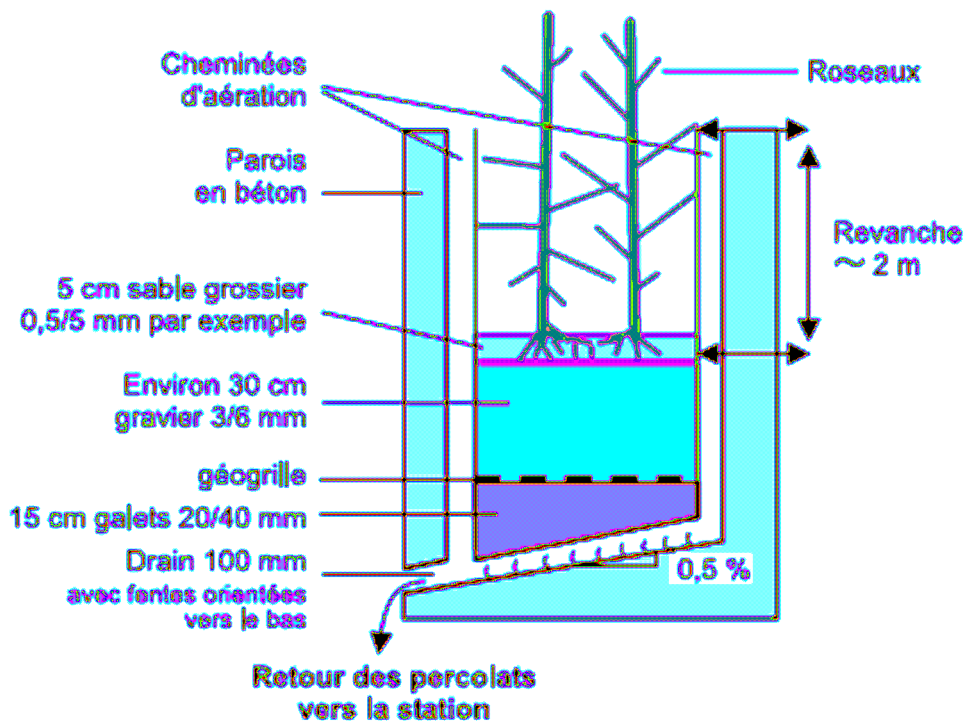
Coupe schématique d'un lit de séchage planté de roseaux avec construction en béton
